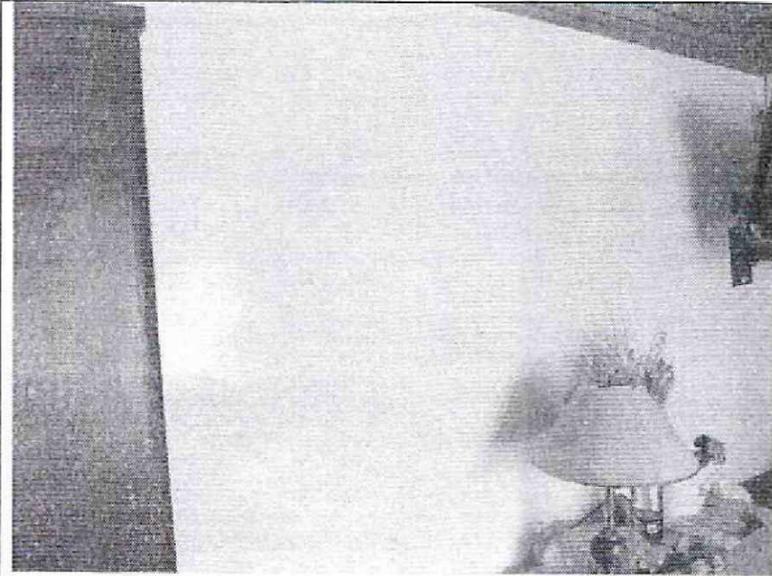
Fisura en la superficie del muro del costado sur.
